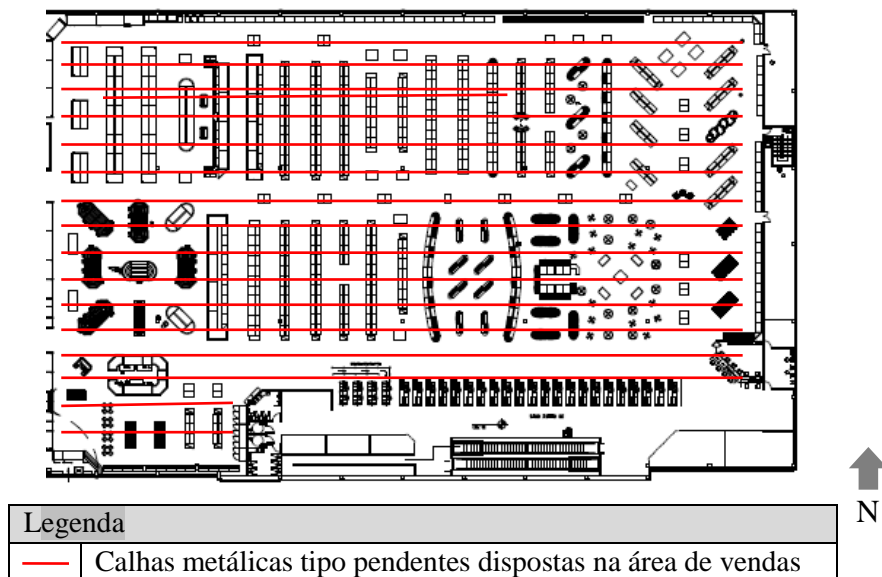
Planta baixa do 1º pavimento do hipermercado com a indicação das luminárias existentes.
